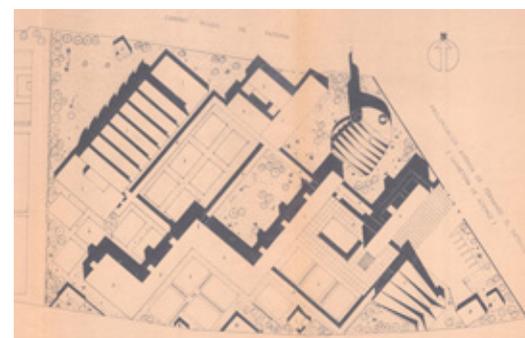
Planimetría general del complejo de las Escuelas Profesionales San José. Fuente: COACV
